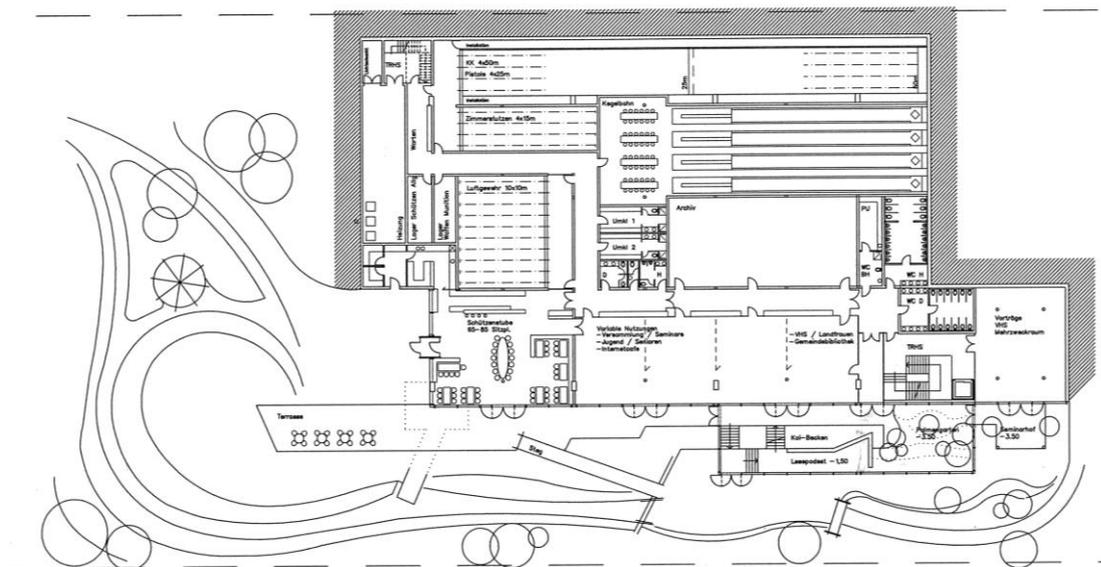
EG-Grundriss: Die 2. Rettungswege wurden bereits im Wettbewerb stark überdimensioniert
